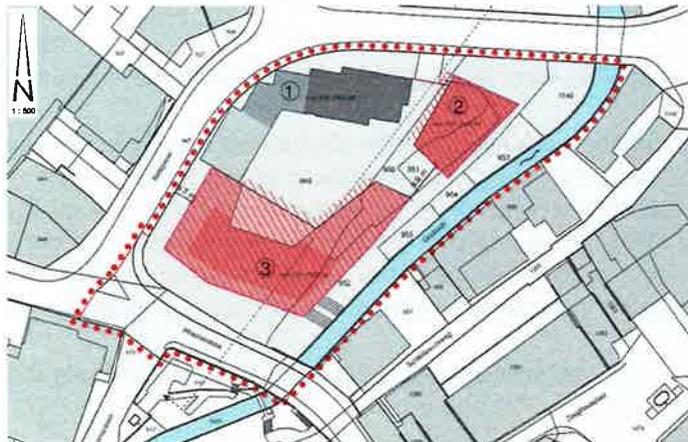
Ausschnitt rechtsgültiger Quartierplan Rebgarten
